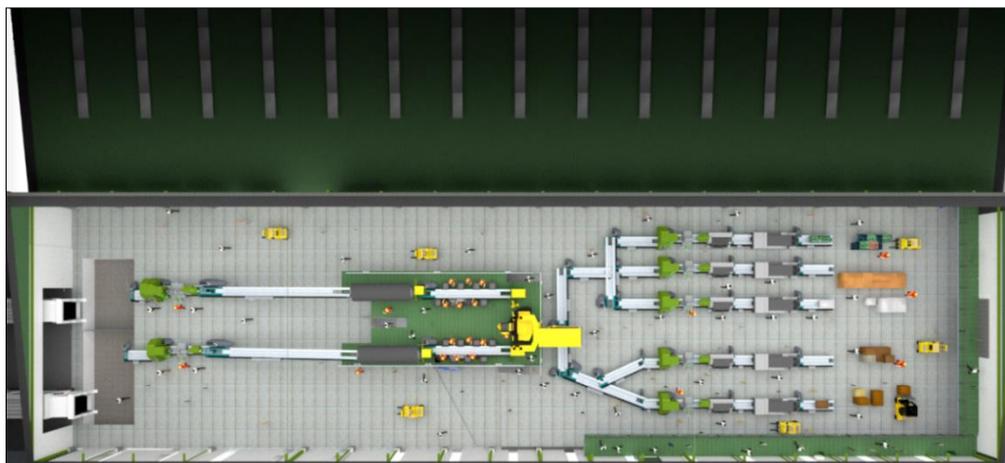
Vista en planta de la zona de segregación de RSU, Fuente: Elaboración propia
